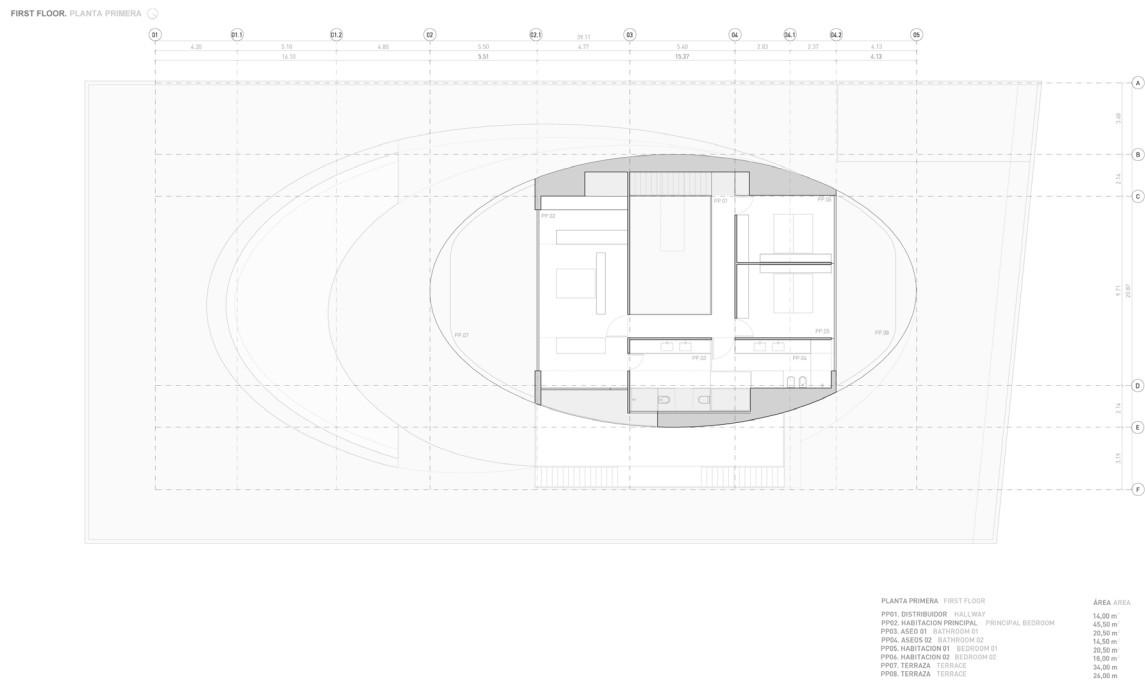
4. Plano planta primera. Fuente: Fran Silvestre Arquitectos.
